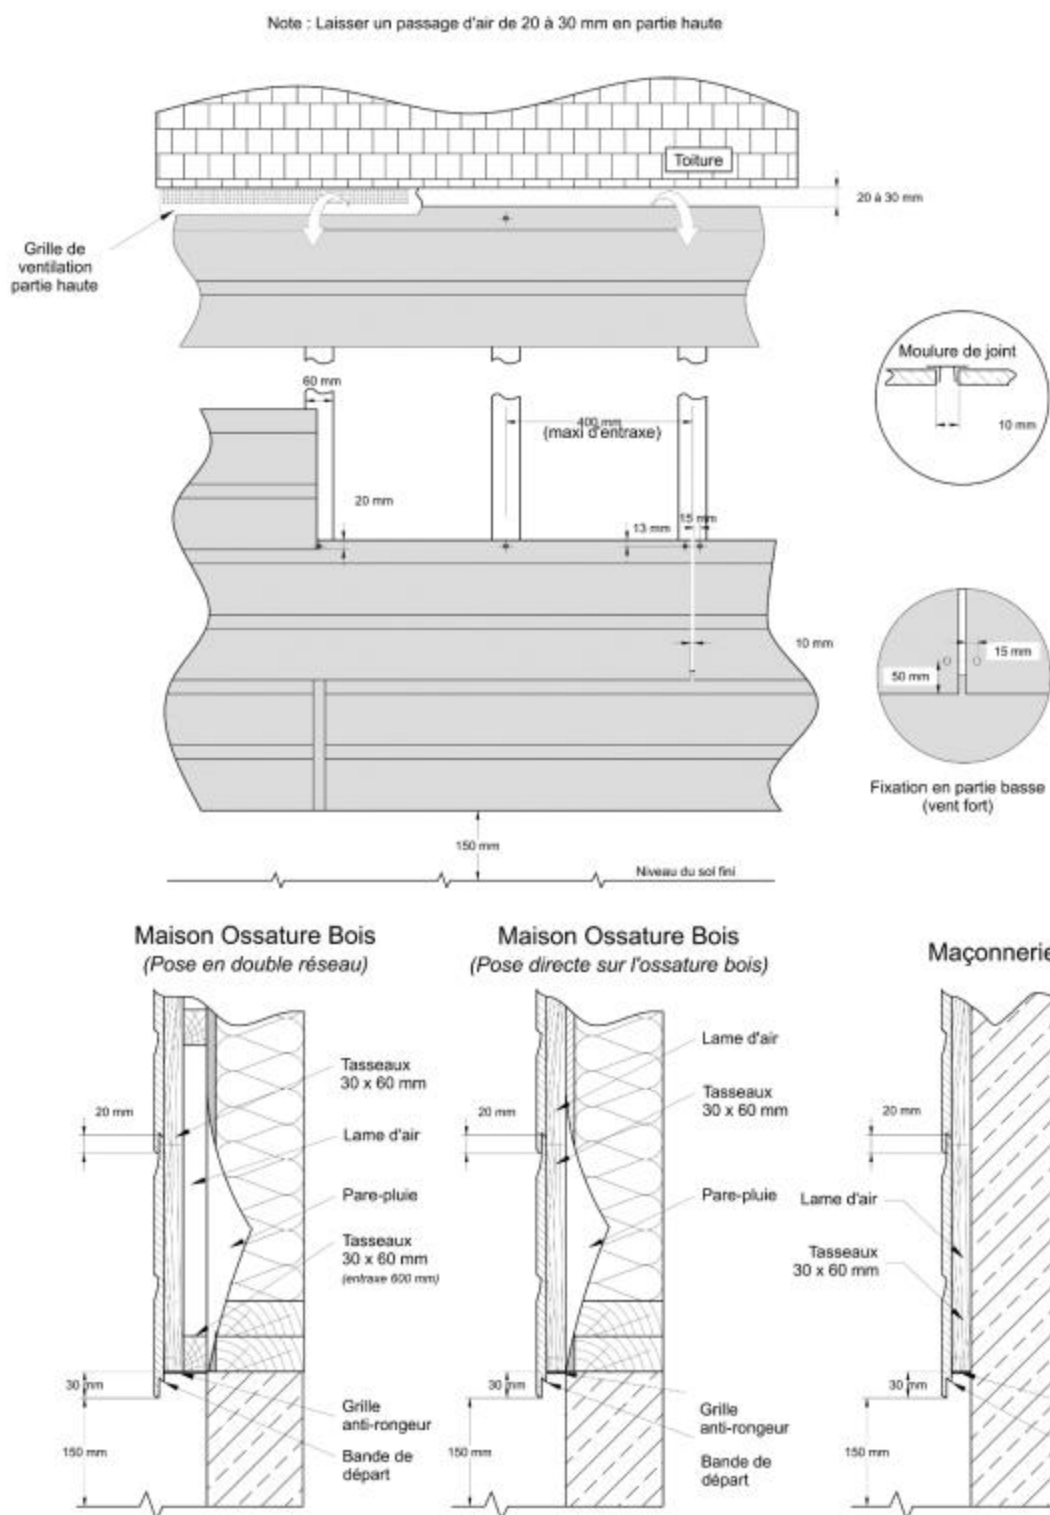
Pose horizontale RIDGEWOOD®, VSTYLE® ≤ 400 mm
